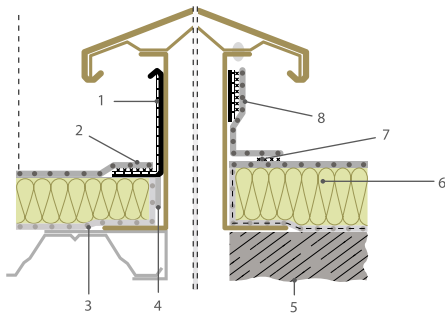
Примыкание пароизоляции ROCKbarrier и гидроизоляционной мембраны ROCKmembrane к выступающим элементам на покрытии.
